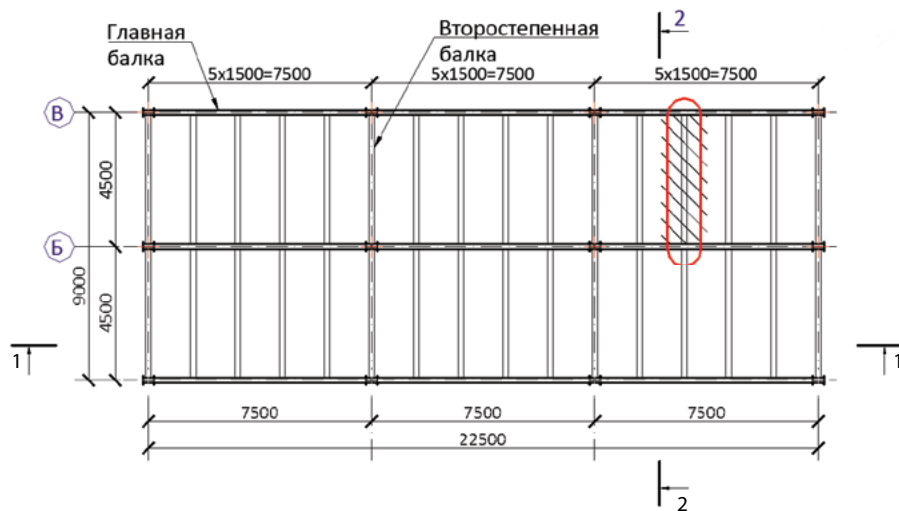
План расположения элементов перекрытия каркаса
